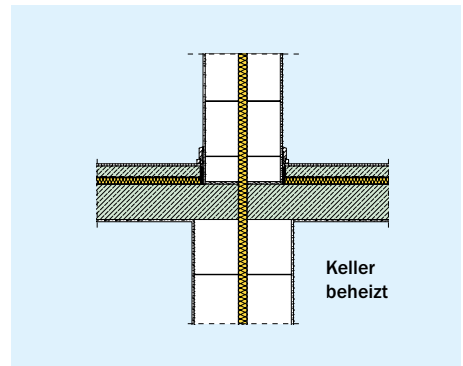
Zwischendeckenanschluss einer zweischaligen Haustrennwand
